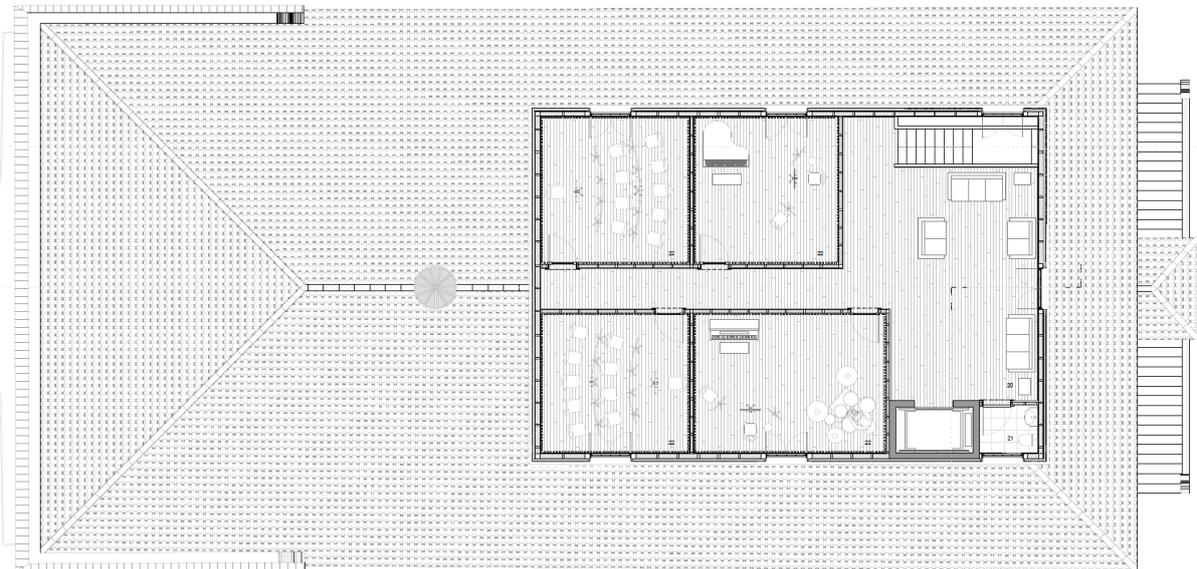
Planta Piso 2, Proposta de Intervenção<sup>16</sup>
